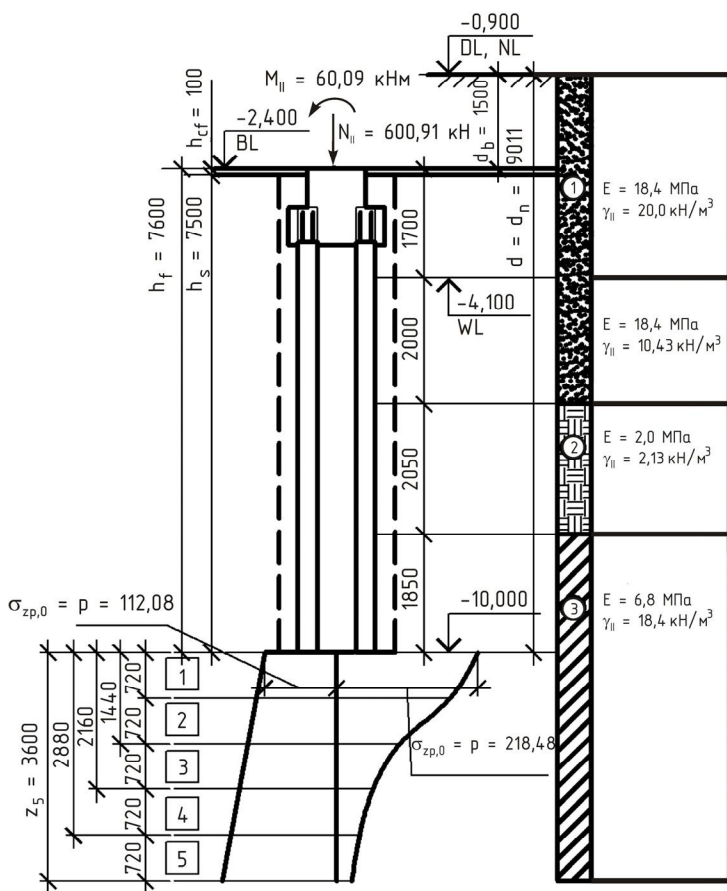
Расчетная схема для определения осадки к примеру 9.4
